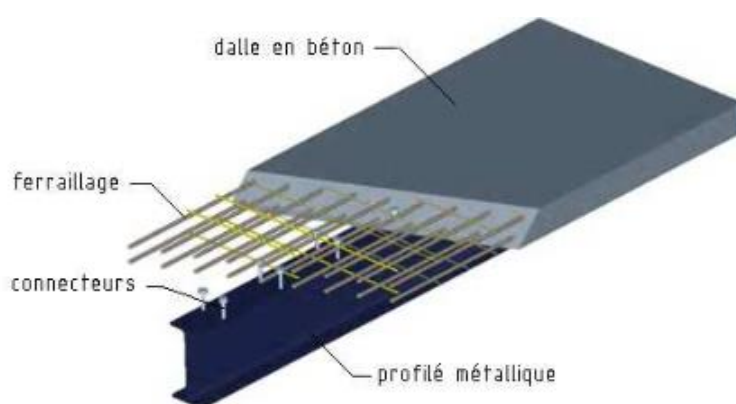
Exemple d'une poutre mixte (source :Cours construction mixte 2iE, Bouchair 2015)
